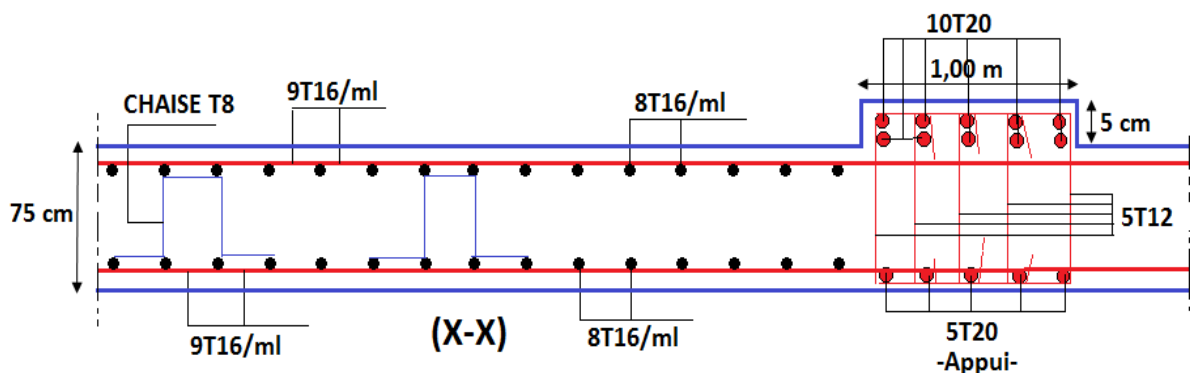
Ferrailages longitudinales du radier (coupe-XX).
